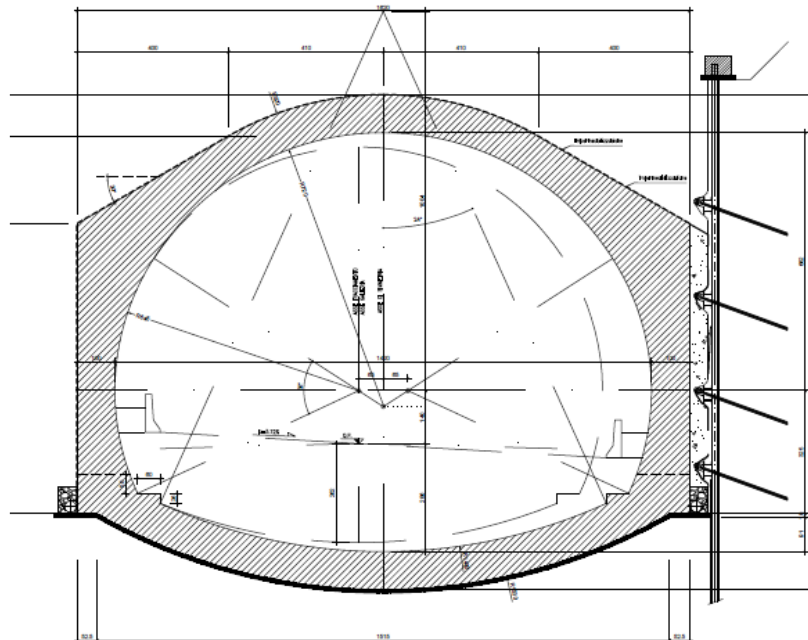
SEZIONE TRASVERSALE GALLERIA ARTIFICIALE ALLARGATA A DX DI 130 CM IN CORRISPONDENZA BERLINESE
